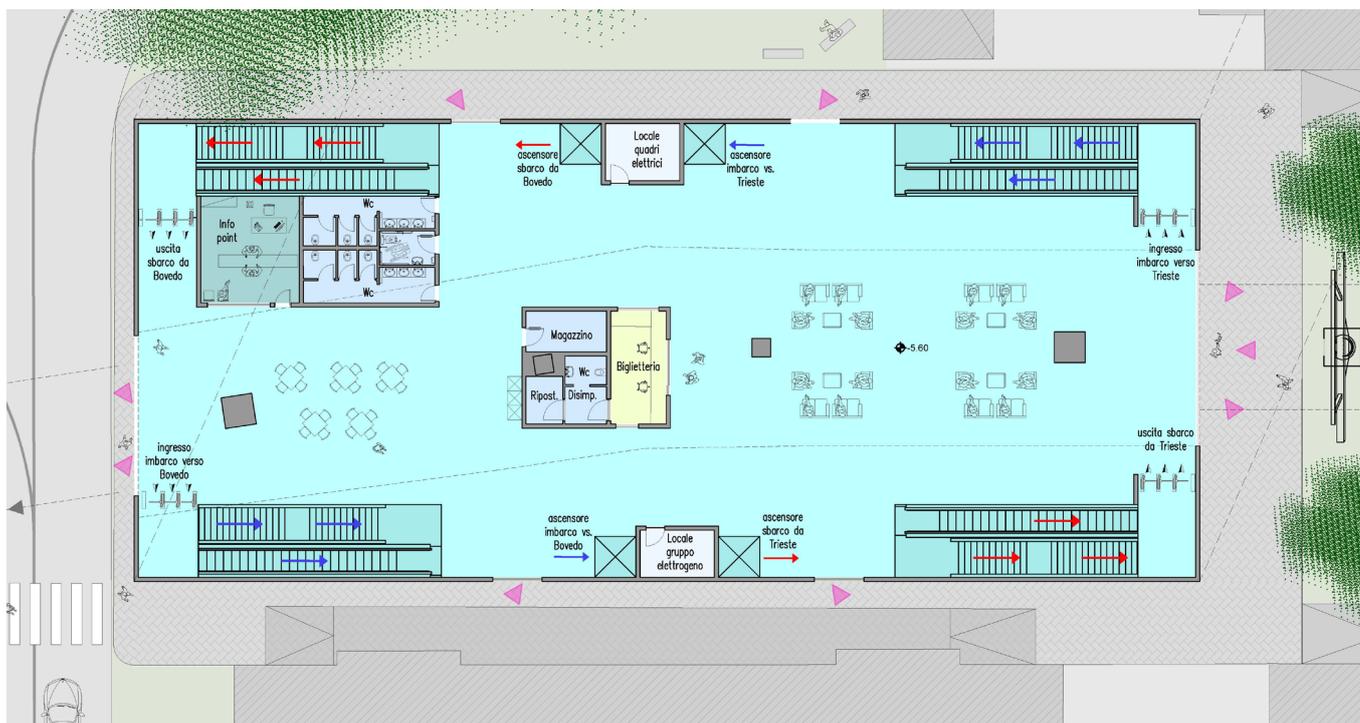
Planimetria piano terra stazione intermedia "Porto Vecchio" con distribuzione locali.
